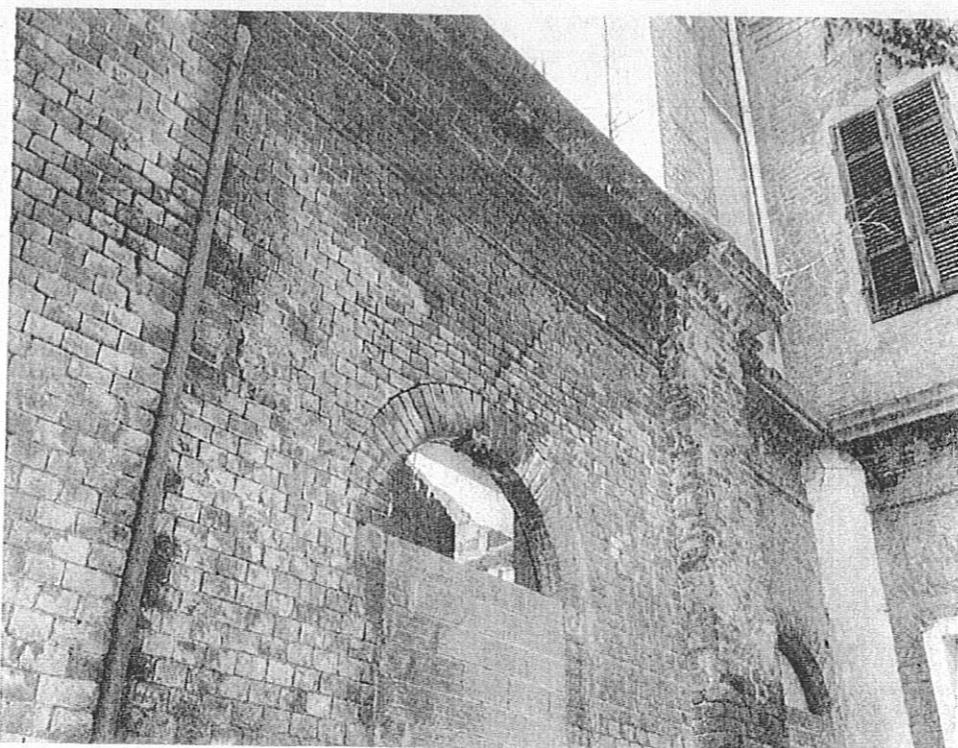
Fessura inclinata a 45° sulla parete est dell'avancorpo con terrazzo
